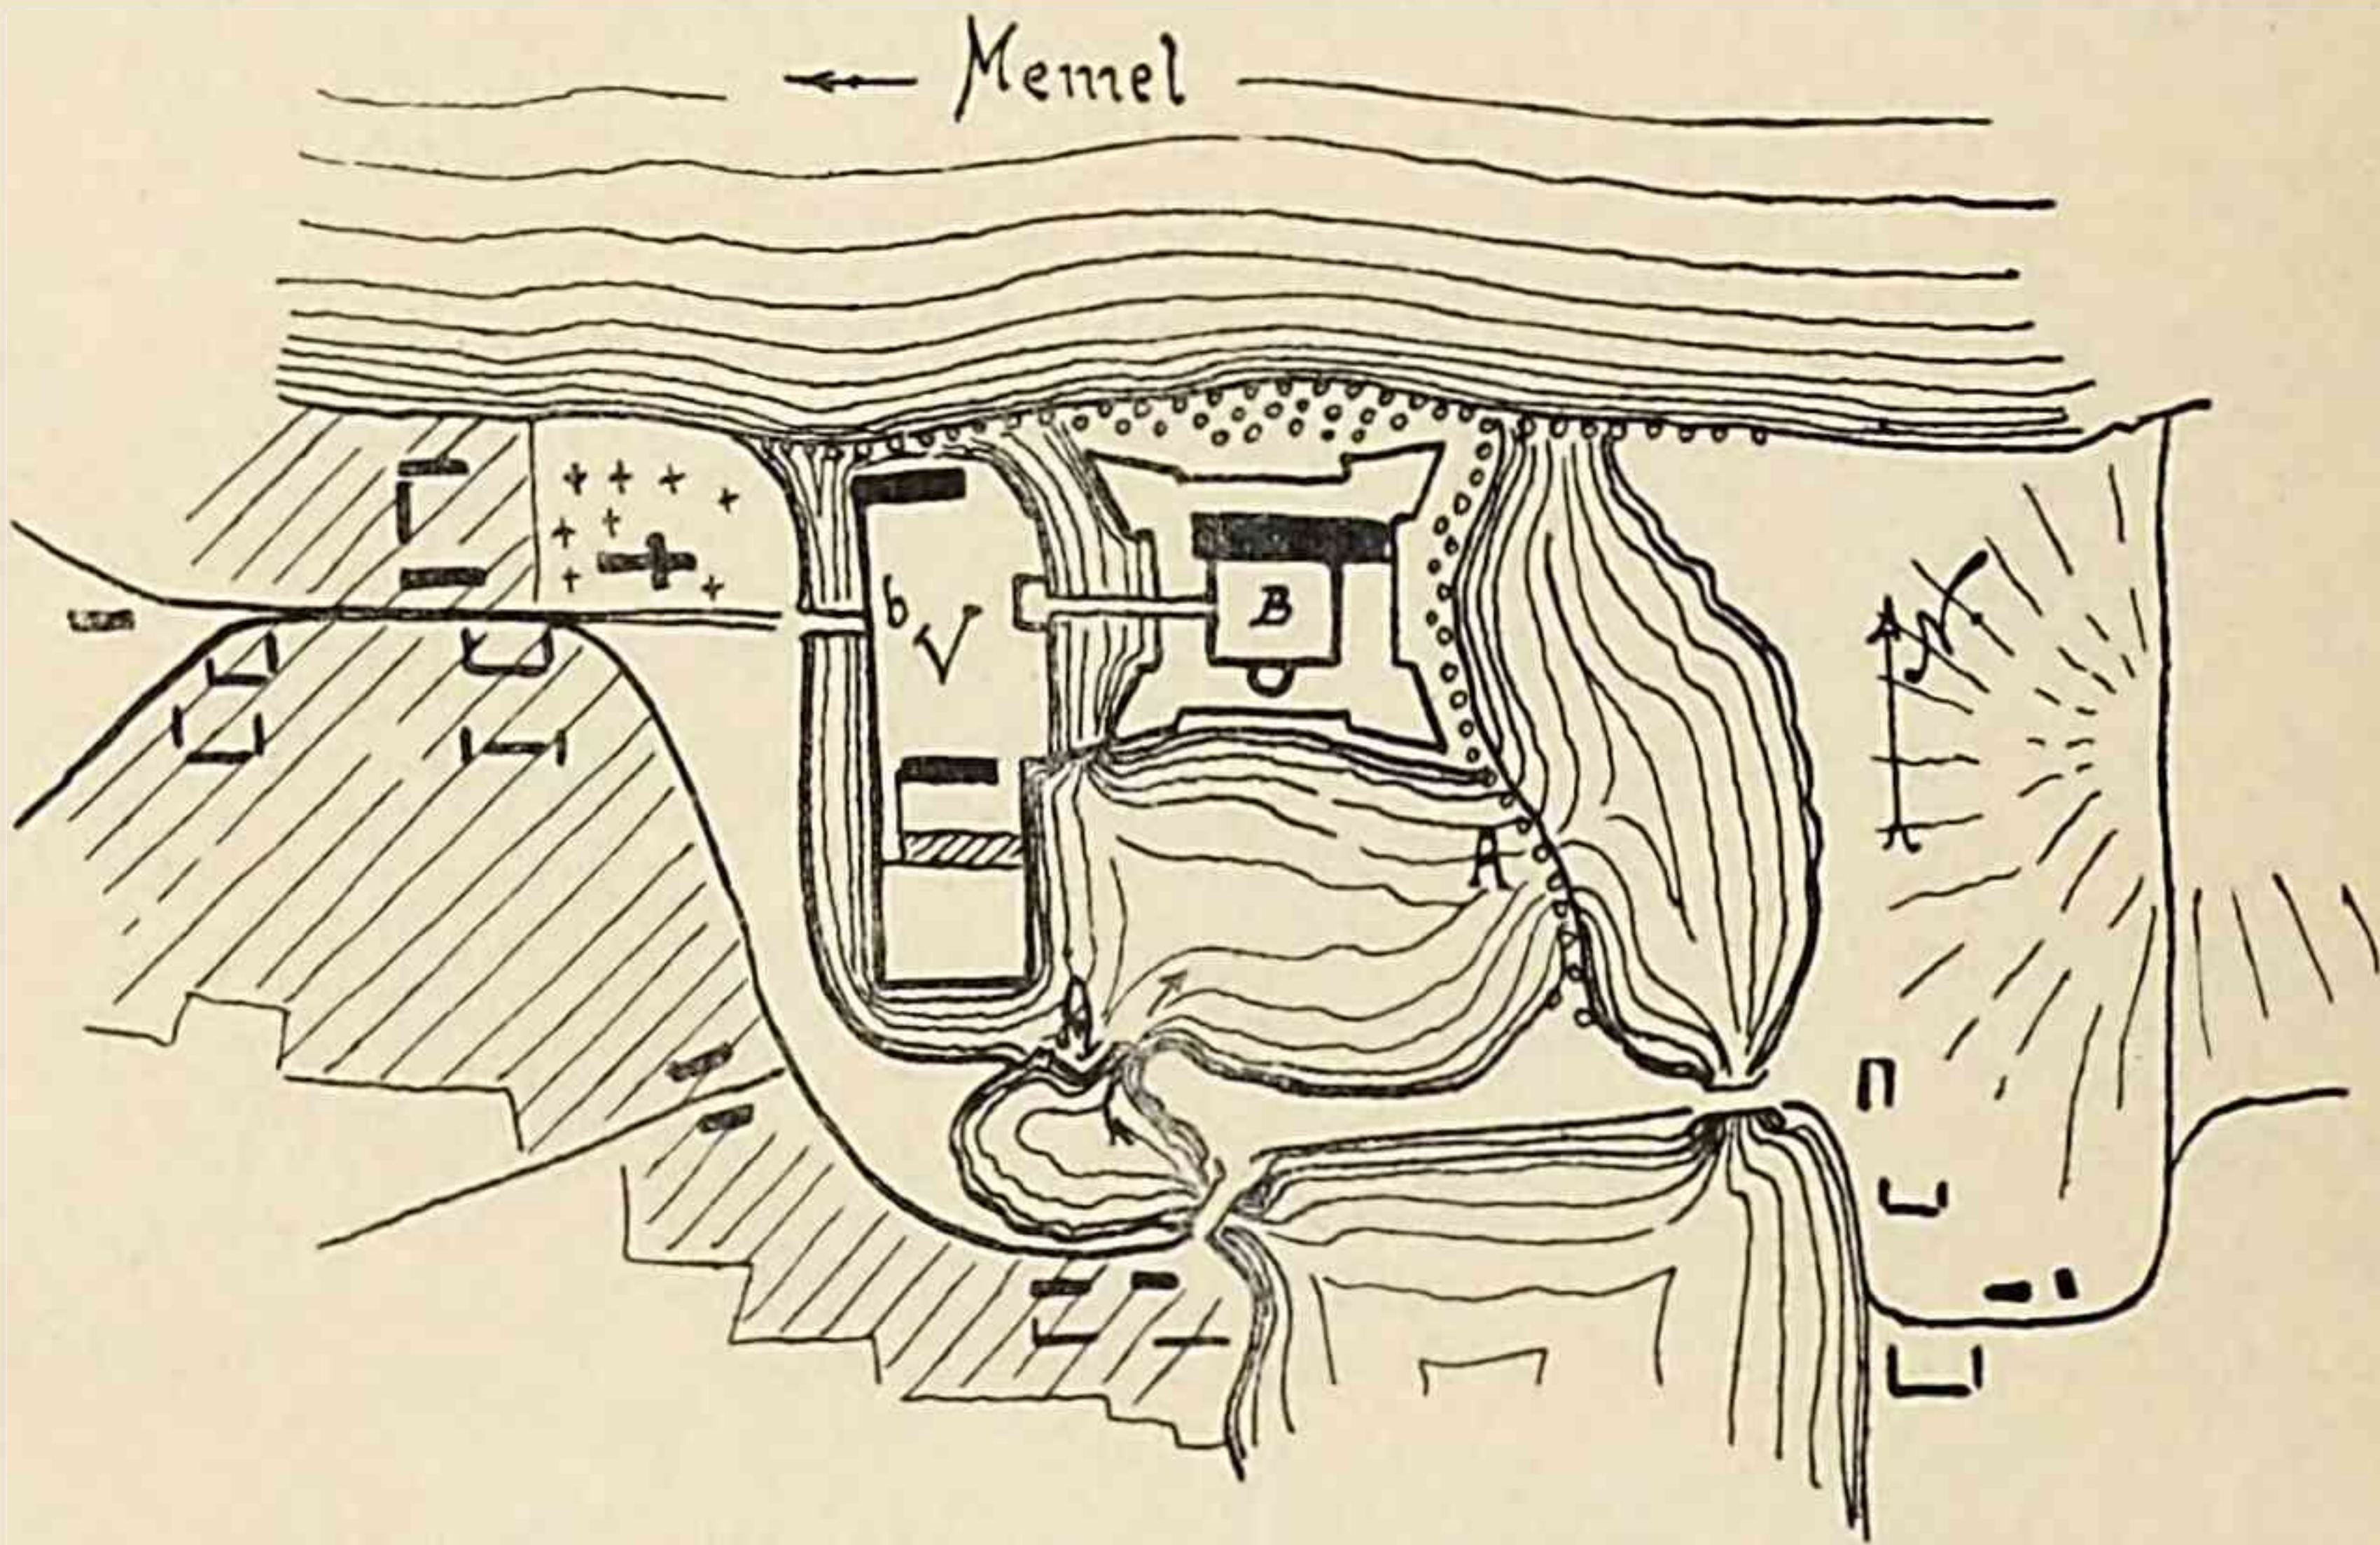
Lageplan der Burg Tilsit nach Giese.
